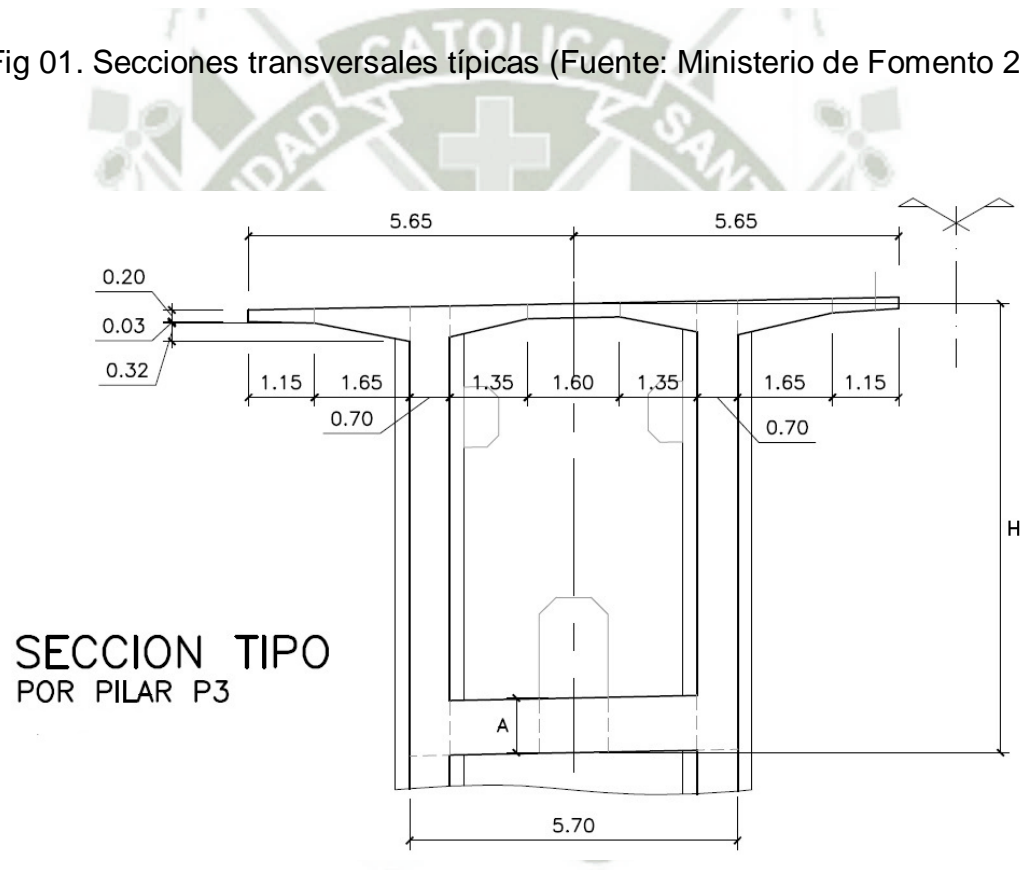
Sección Transversal Típica (Pilar 03 – Puente Chilina, Plan Técnico
